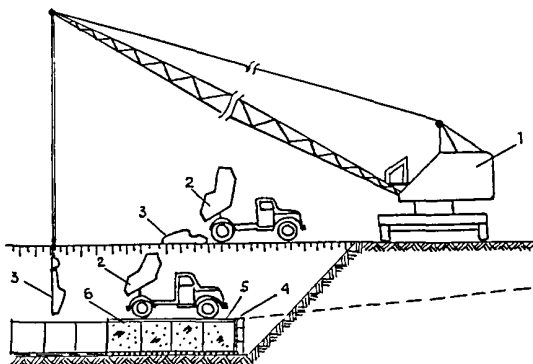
Одновременная укладка бетонной смеси краном с бадьями, из самосвалов с задней и боковой разгрузкой или автобетоновозов непосредственно в плиту:
